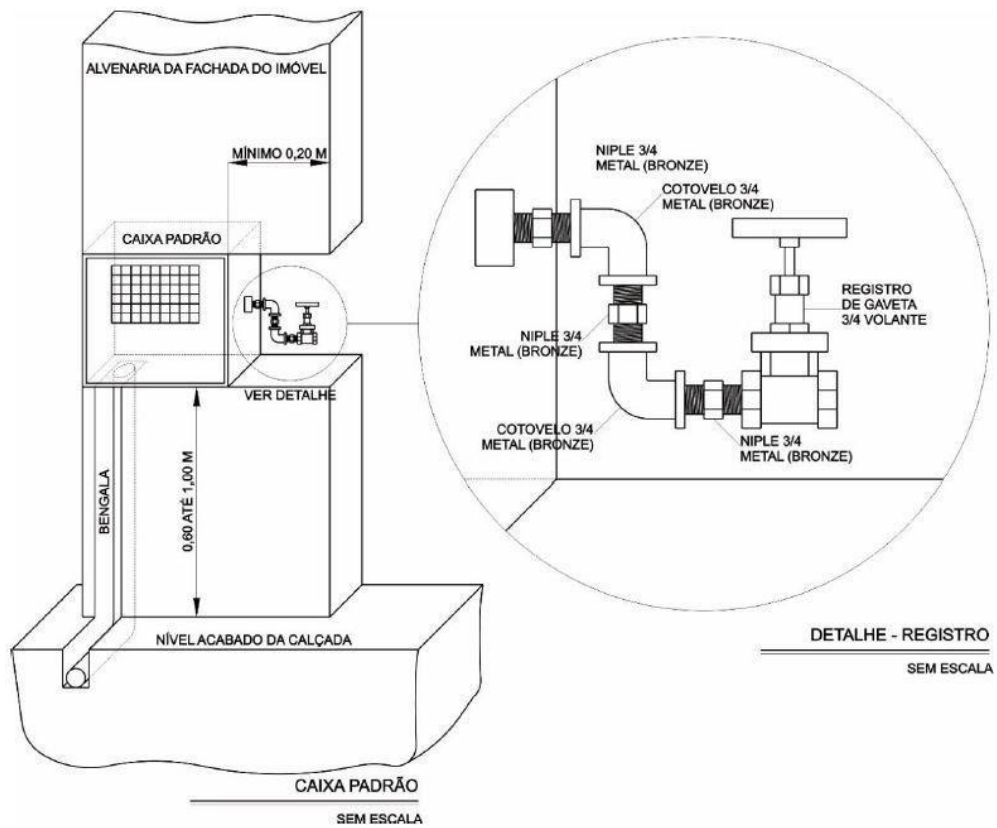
Detalhe de ligação para ligação de caixa padrão.
